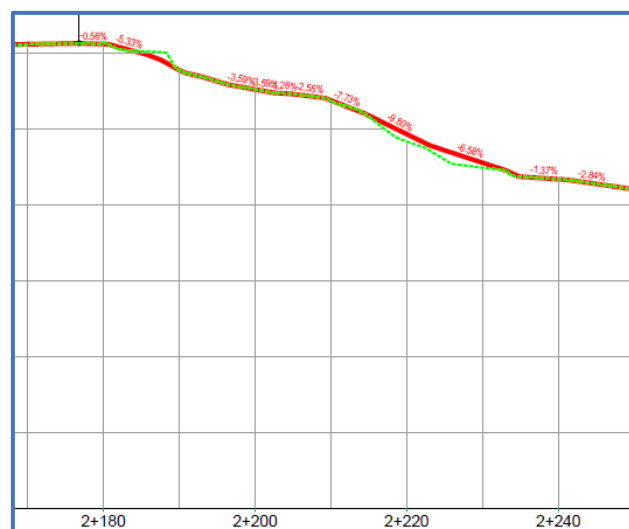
Detalle del perfil longitudinal del carril bici entre el aparcamiento cementerio y la NA-6053.
